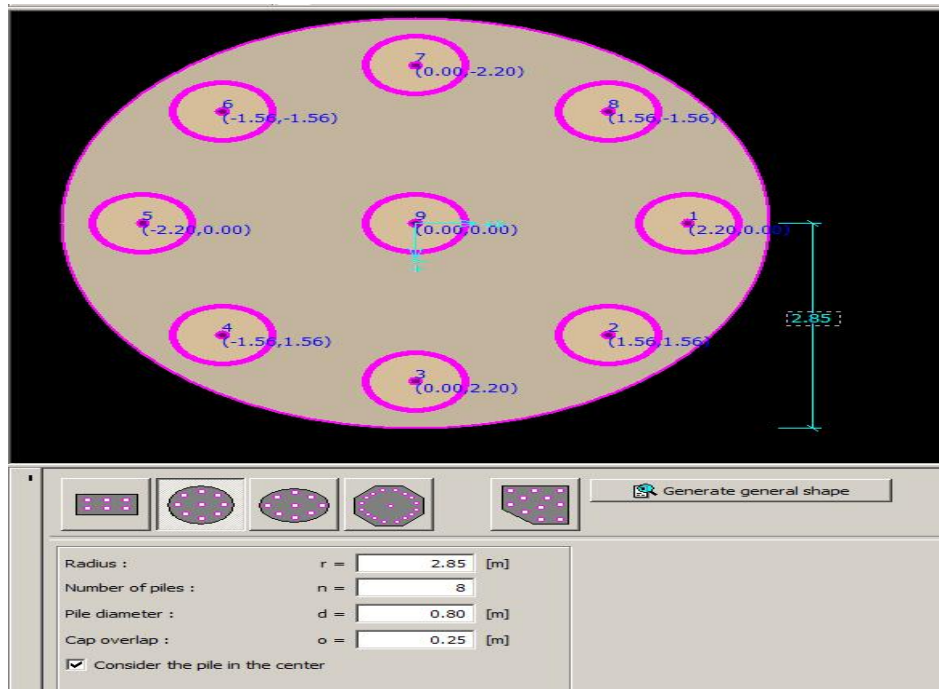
Disposition des pieux de la tour 6 (GEO5 pile groupe).
